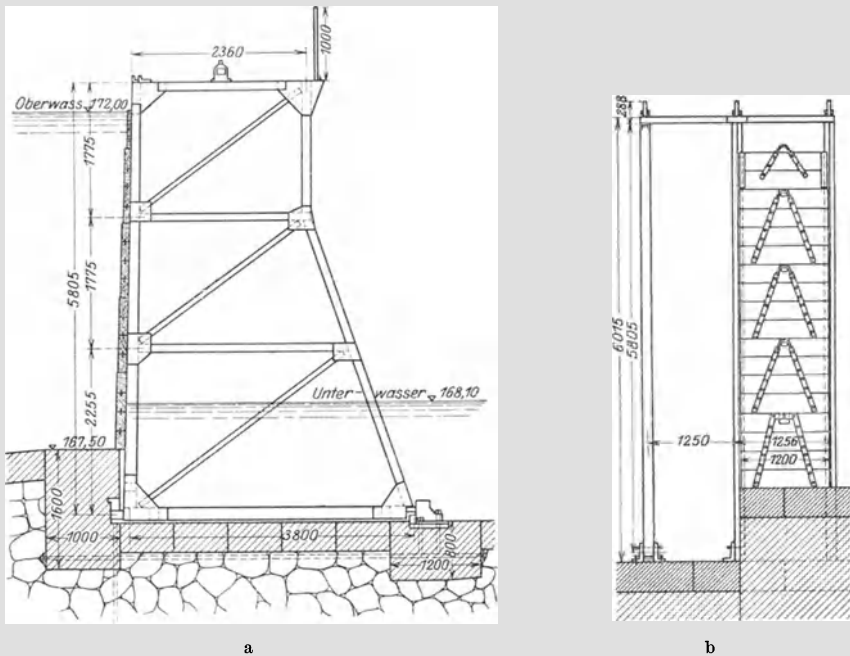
u. b. Schützenwehr bei Liebschitz. Maßstab 1 : 100.
